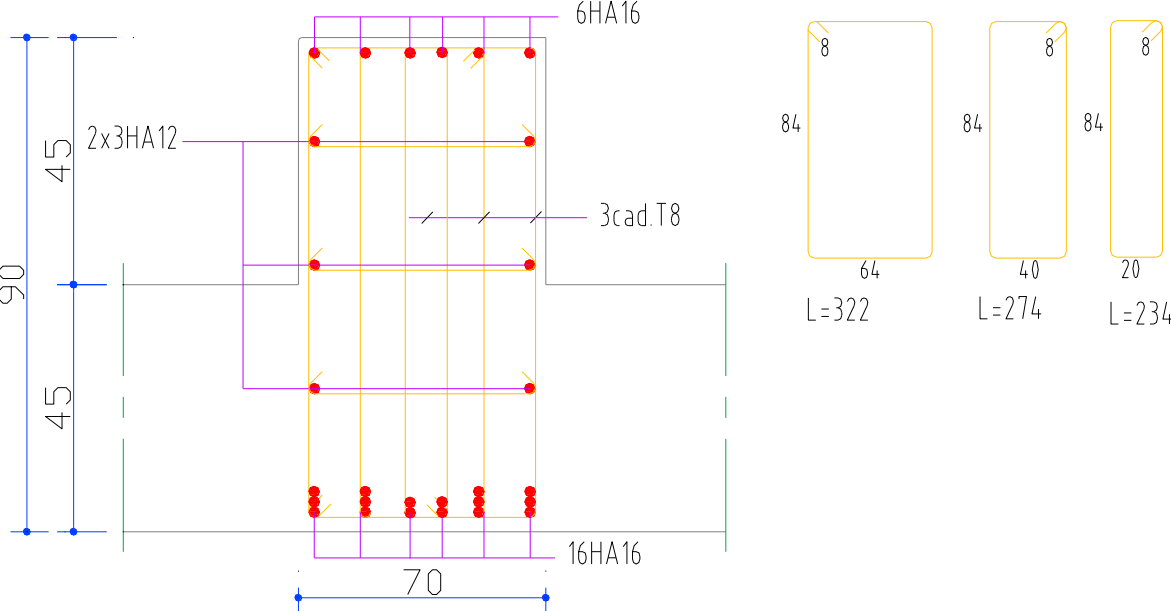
Coupe de ferrailage des nervures principales au niveau appuis.
